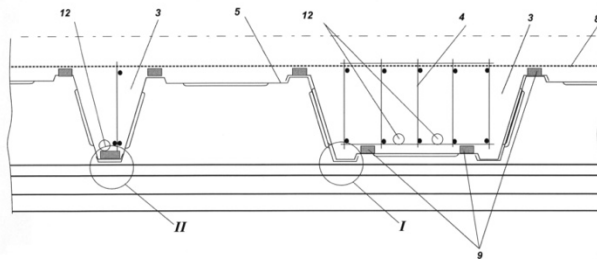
Увеличенный фрагмент сборки опалубки для возведения, например, перекрытия, где показано соединение каждого элемента друг с другом [4], где: 3 – кессонообразователи; 4 – рабочие арматурные каркасы; 5 – основание-полка; 6 – отбортовка; 8 – арматурная сетка; 12 – канаты.
